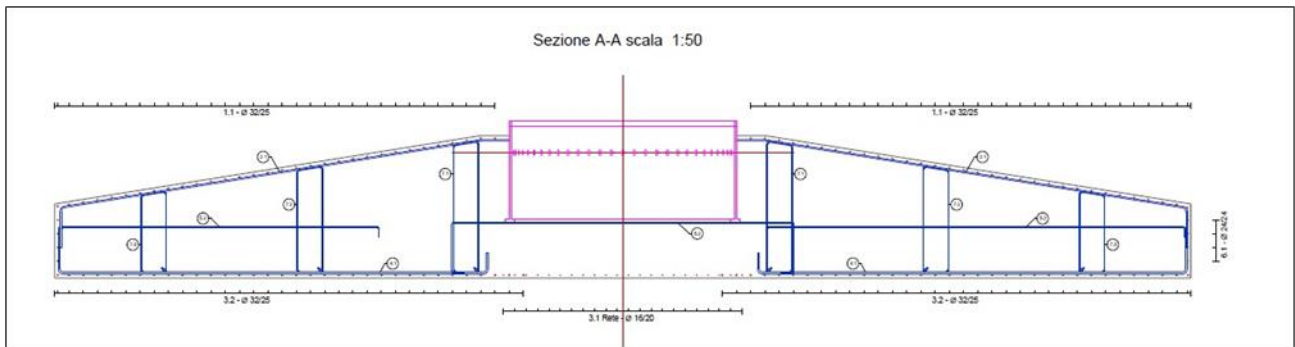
sezione tipo del plinto di fondazione dell'aerogeneratore e dettaglio dello scavo
